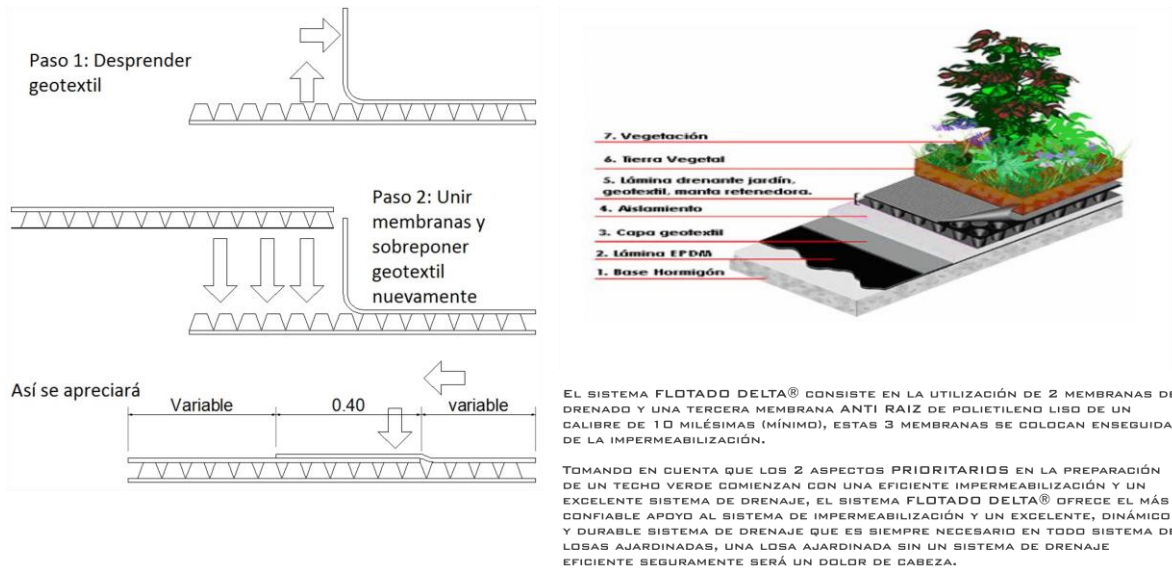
detalle Cubierta verde Sistema Flotado Delta
